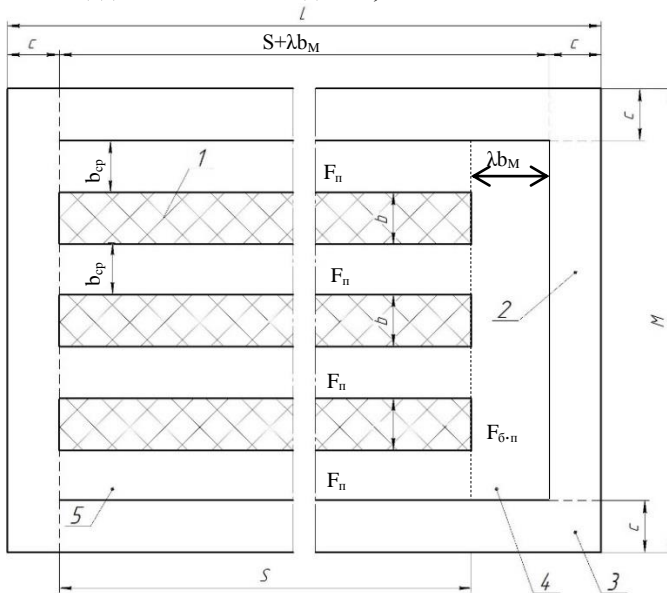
Схема к расчету площади зоны хранения машин на открытых площадках
